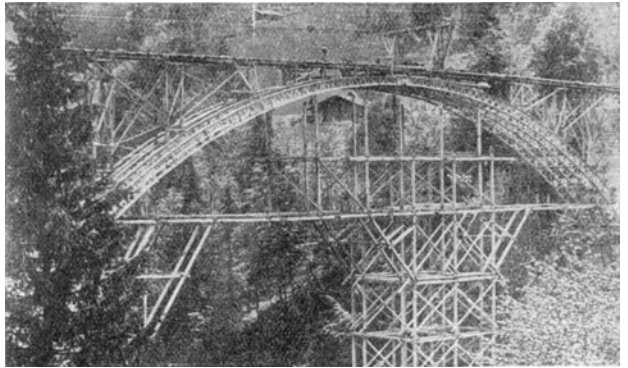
Brücke über die Grande Eau bei Les Planches. Eiserne Gitterbögen aufgestellt, Montagegerüst im Abbruch.
